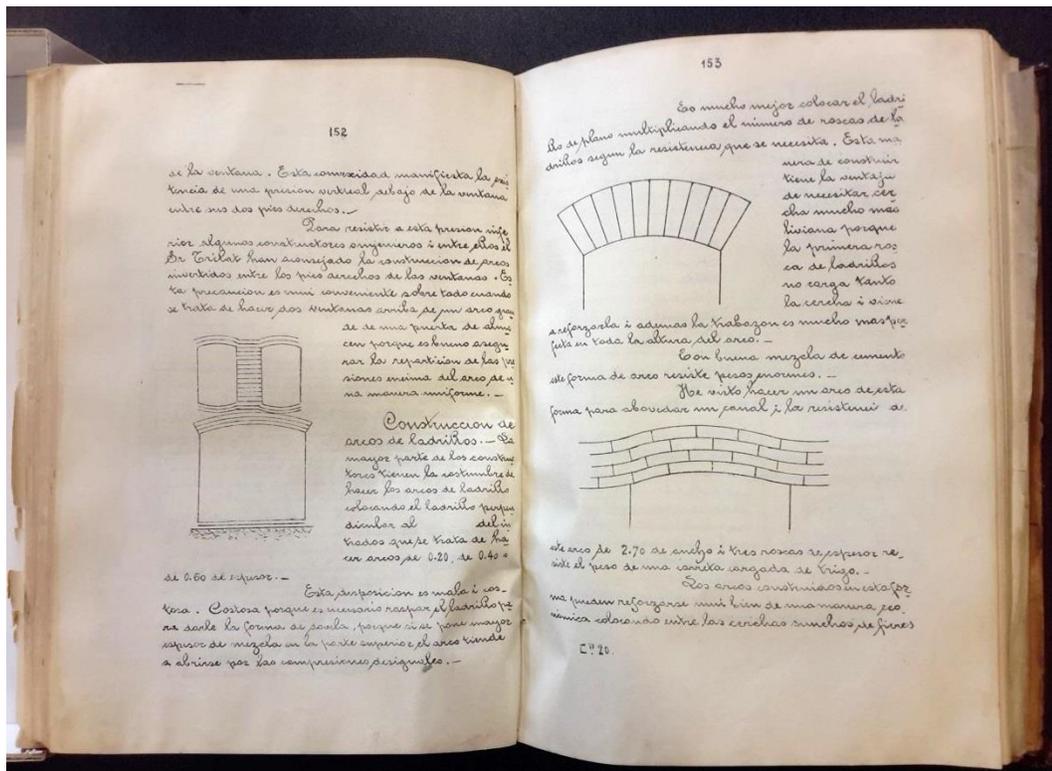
Texto de apuntes del curso de construcción. Joannon 1911.
